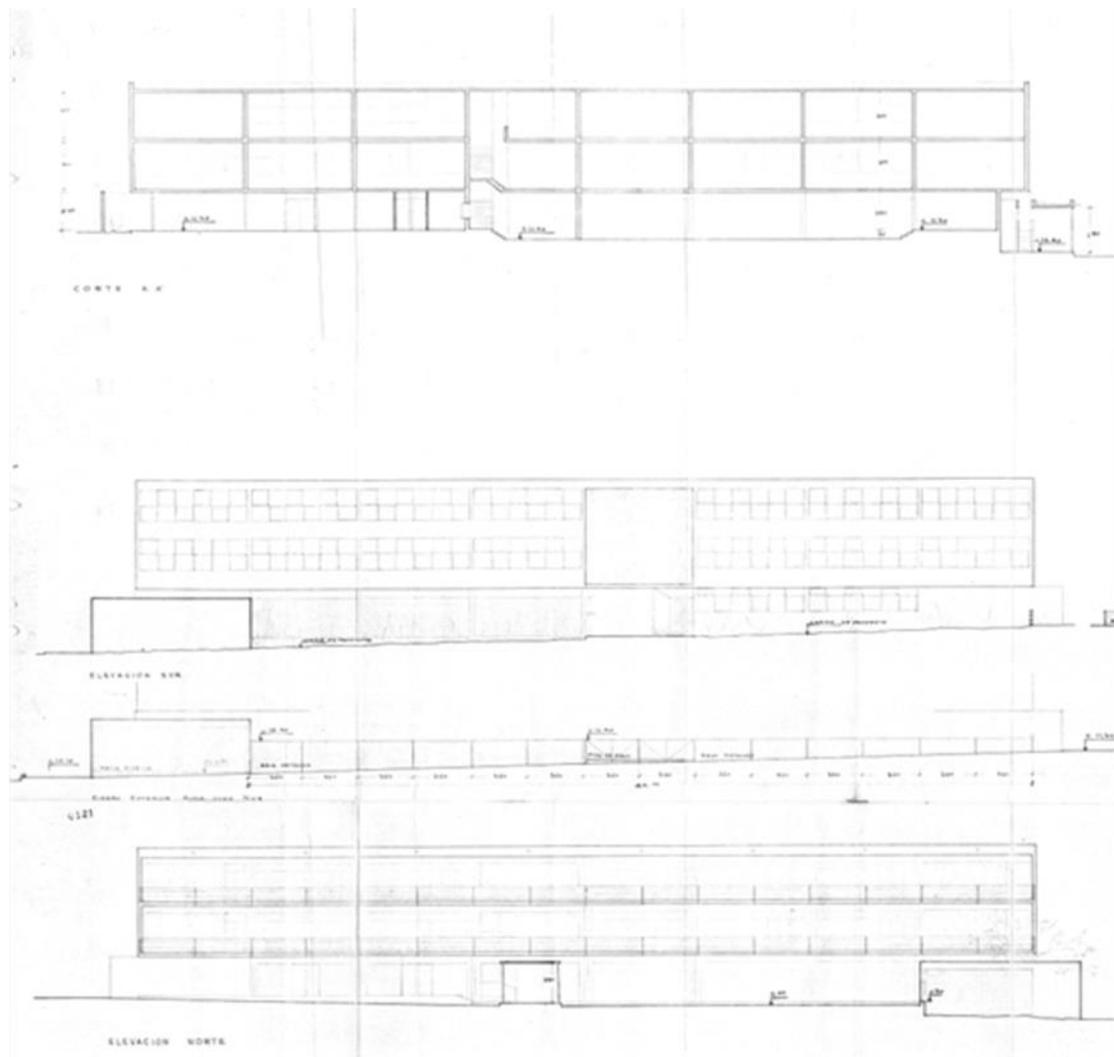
Planos de cortes de Arquitectura, proyecto original, 1962
